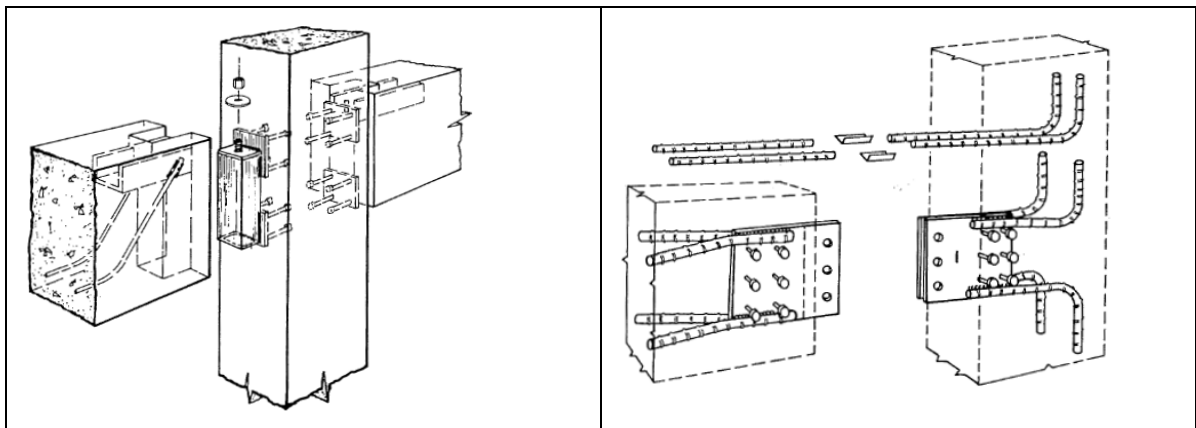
Tipos de ligações viga-pilar sem sucesso
